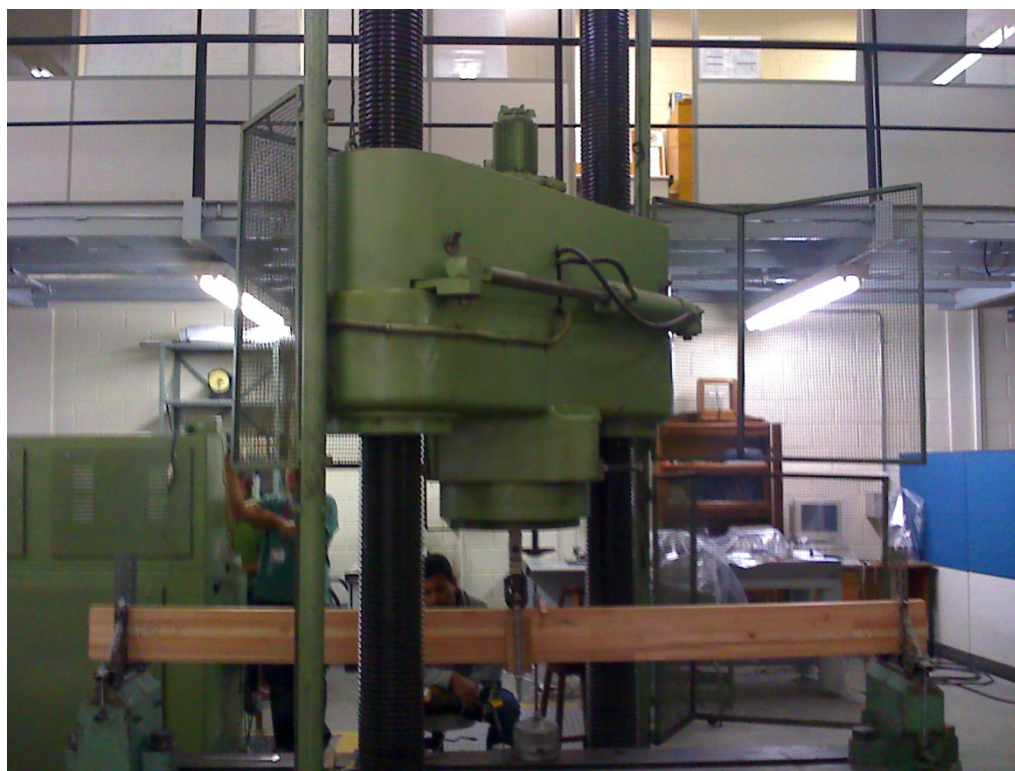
Viga com três metros de vão sendo ensaiada na prensa
